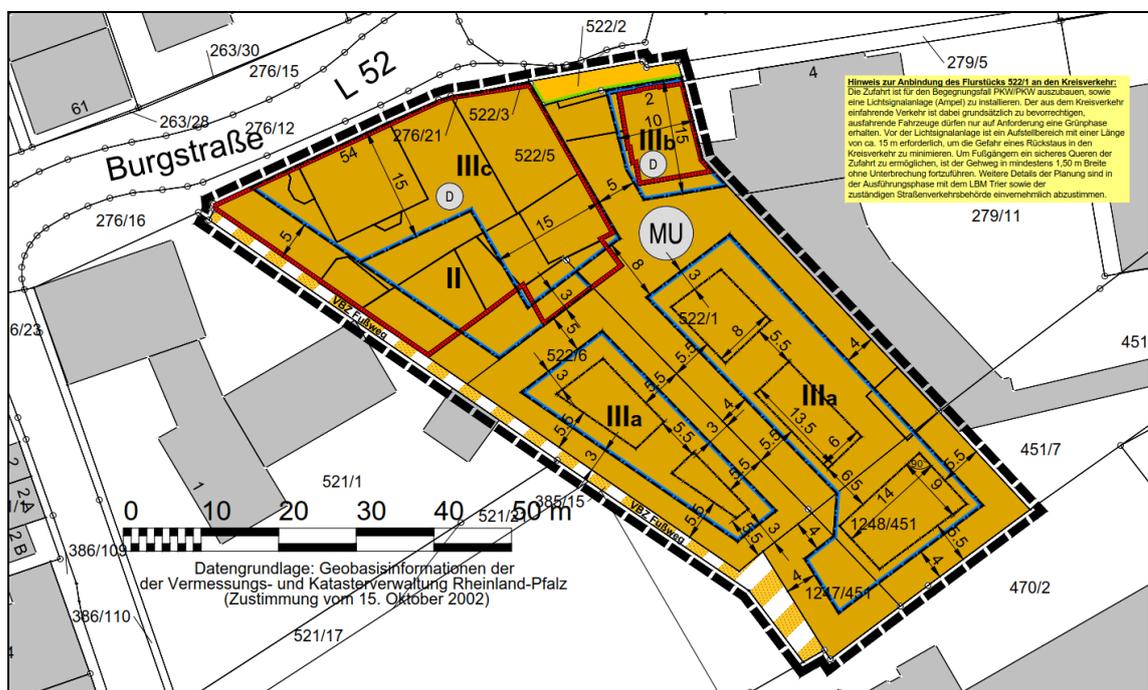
Auszug aus der Planzeichnung zum Satzungsbeschluss
